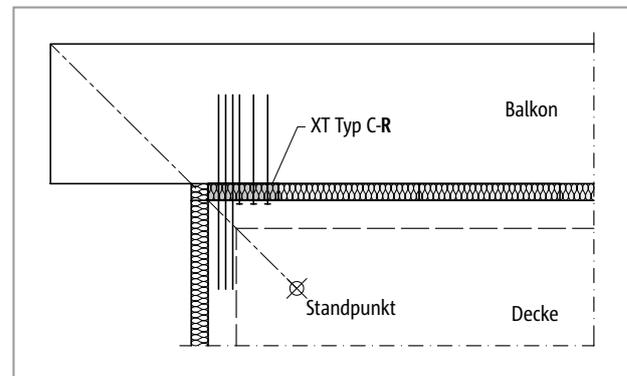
Schöck Isokorb® XT Typ C: Balkon über Gebäudeecke auskragend (Einsatz XT Typ C-R)
